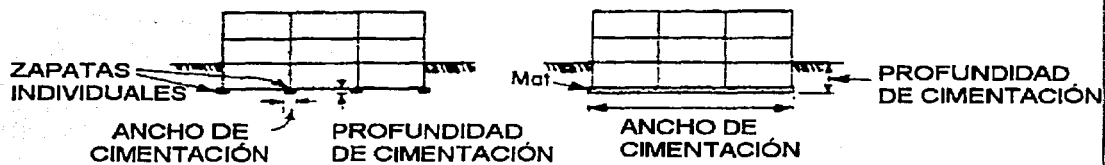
Profundidad y ancho de cimentación para zapatas individuales y losa de cimentación.
